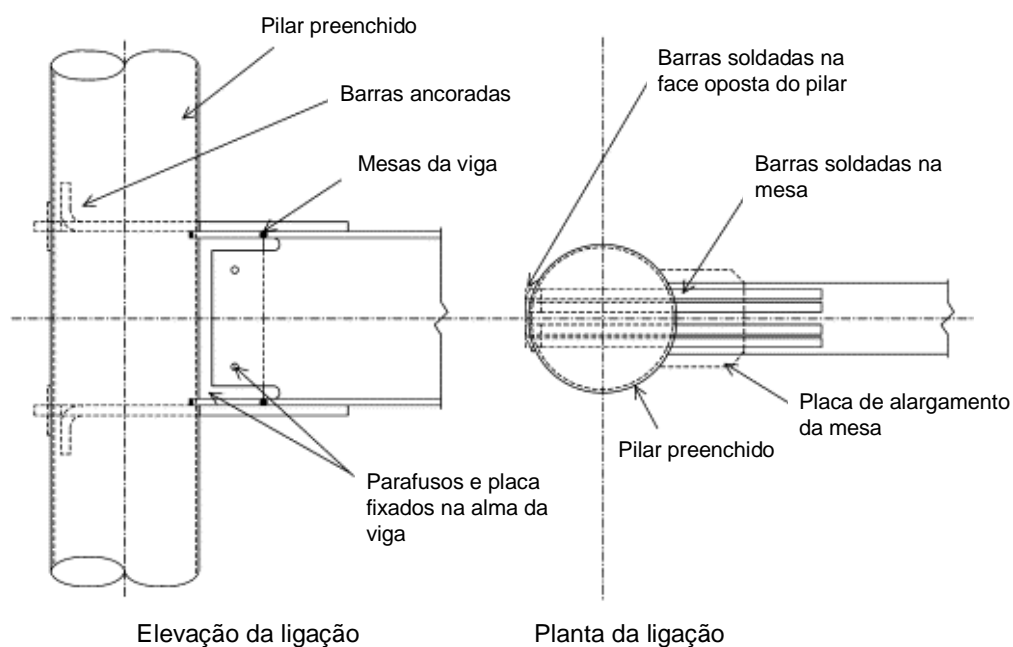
Detalhes das ligações com barras soldadas (BEUTEL *et al.* 2002).
